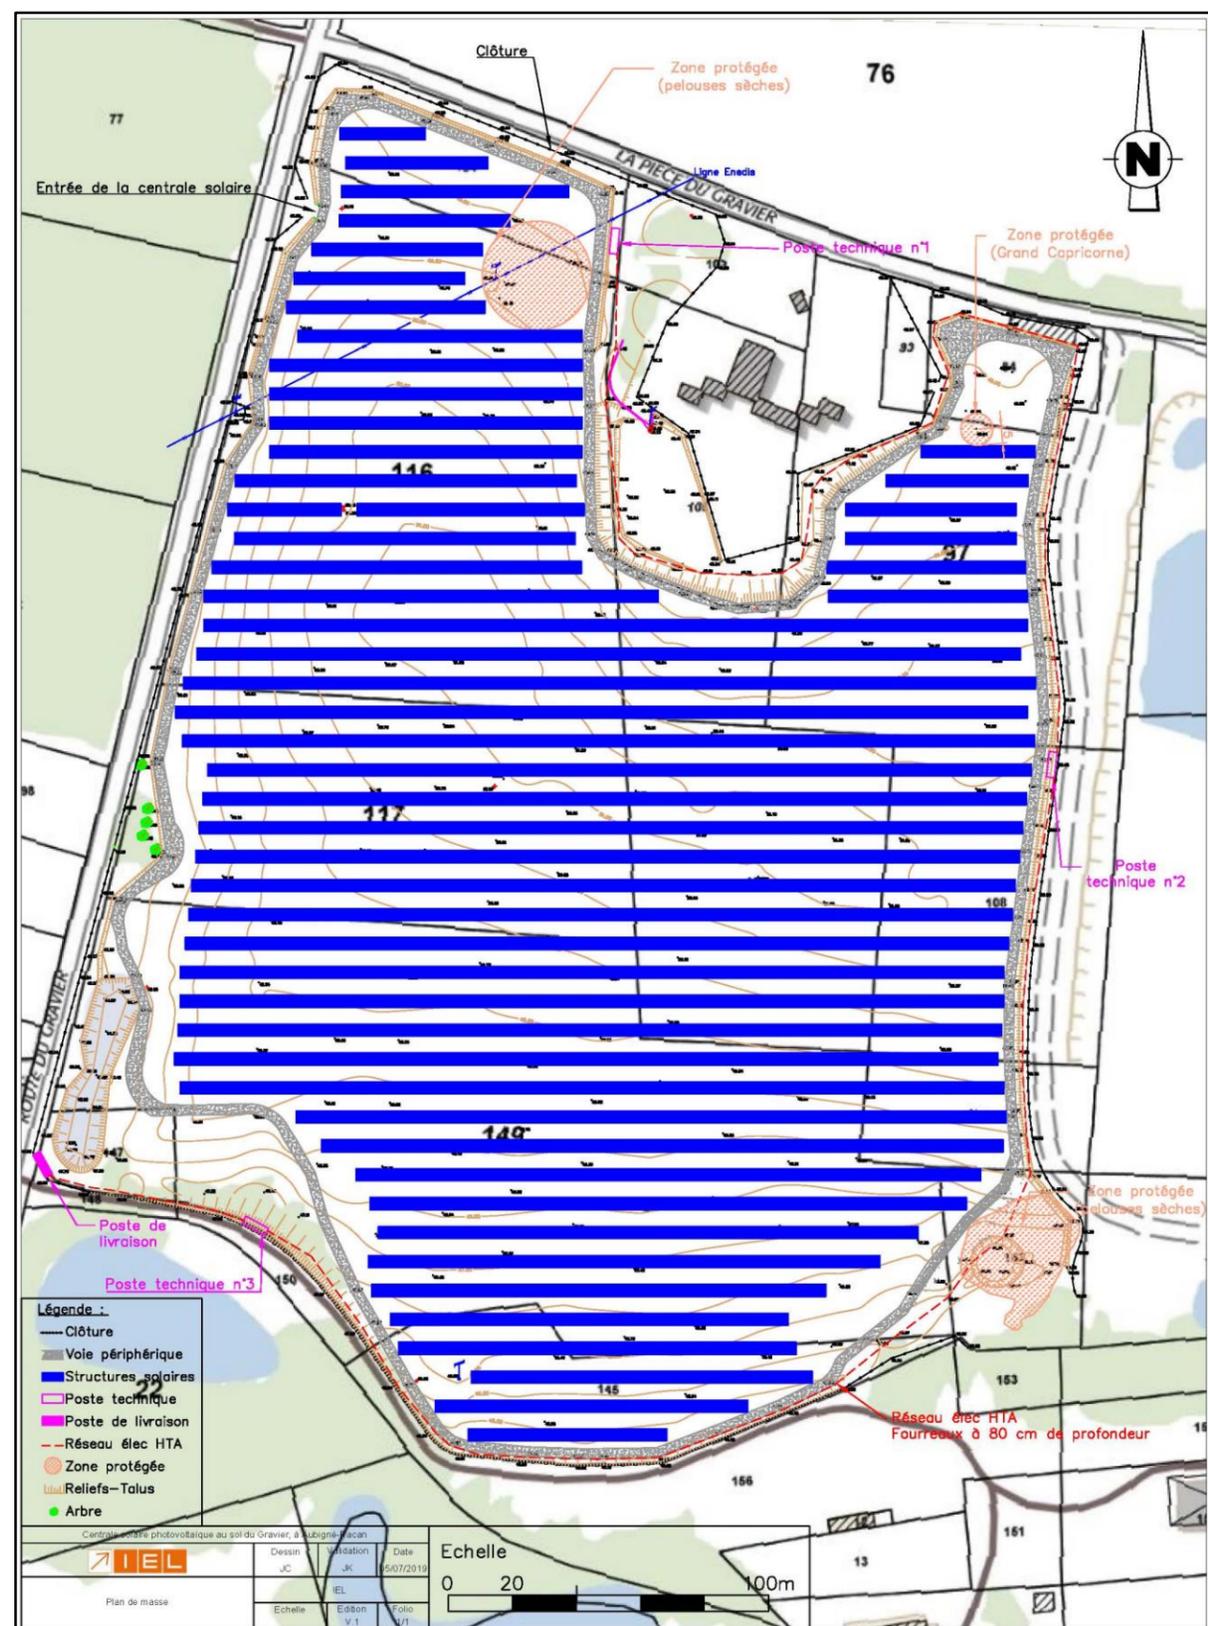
Plan d'implantation du projet d'Aubigné-Racan
